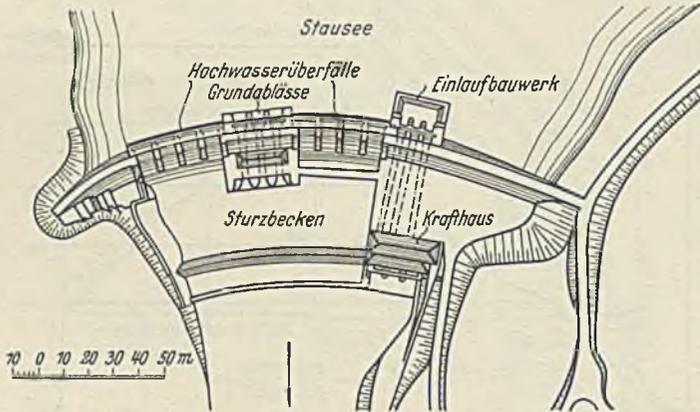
Grundriß der Sperrmauer mit Krafthaus.
